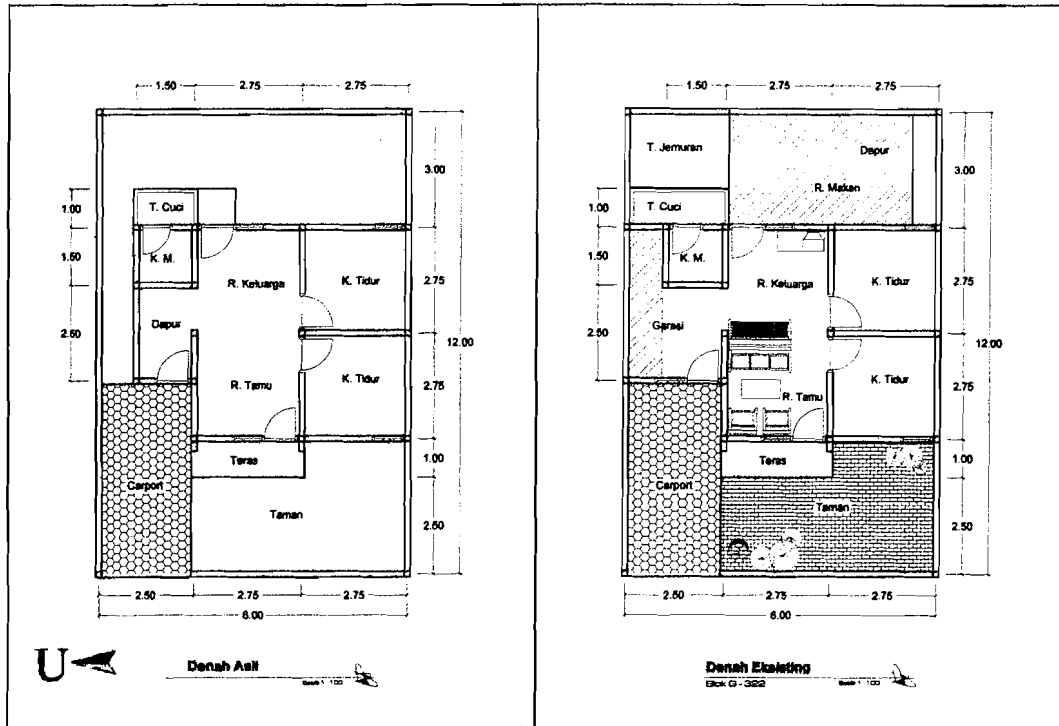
Denah Asli dan Denah Eksisting Blok G 304 yang mengalami pemindahan dapur serta penambahan kamar tidur dan penambahan luasan teras.
